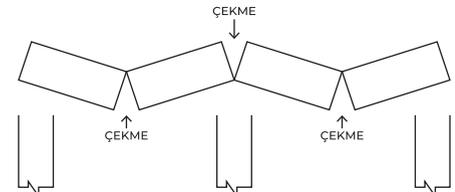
Sürekli Betonarme Elemanın Çekme Gerilmesi Noktaları
